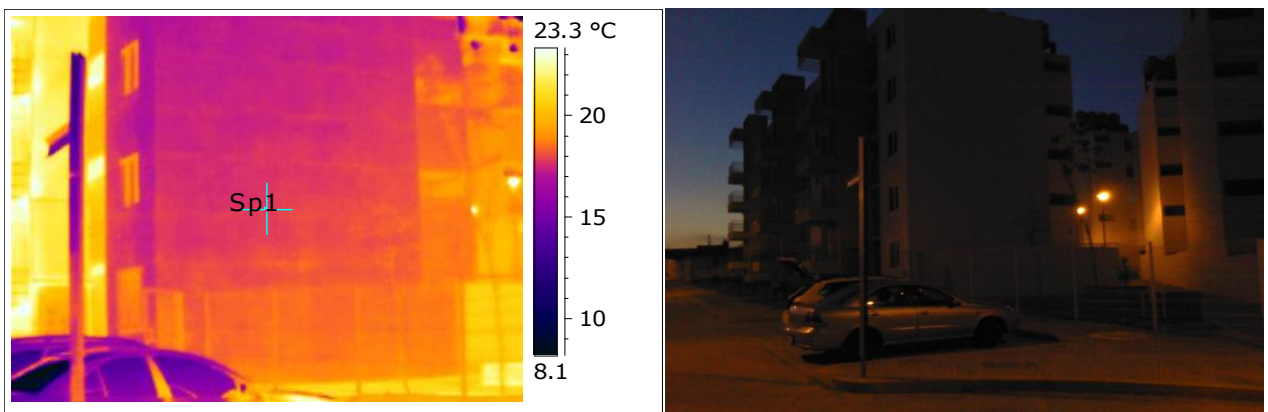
Fachada de Edificio Proyecto Piloto Nama
